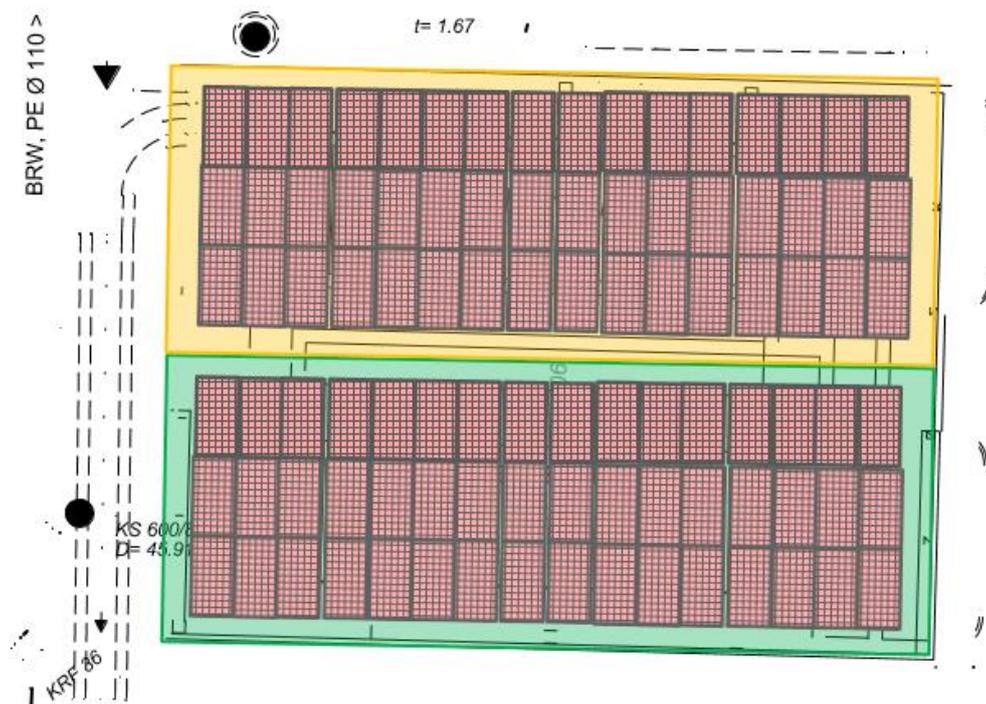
Dachauslegung Lager, maximal 2 mal 12.48 kWp installierte PV-Leistung
